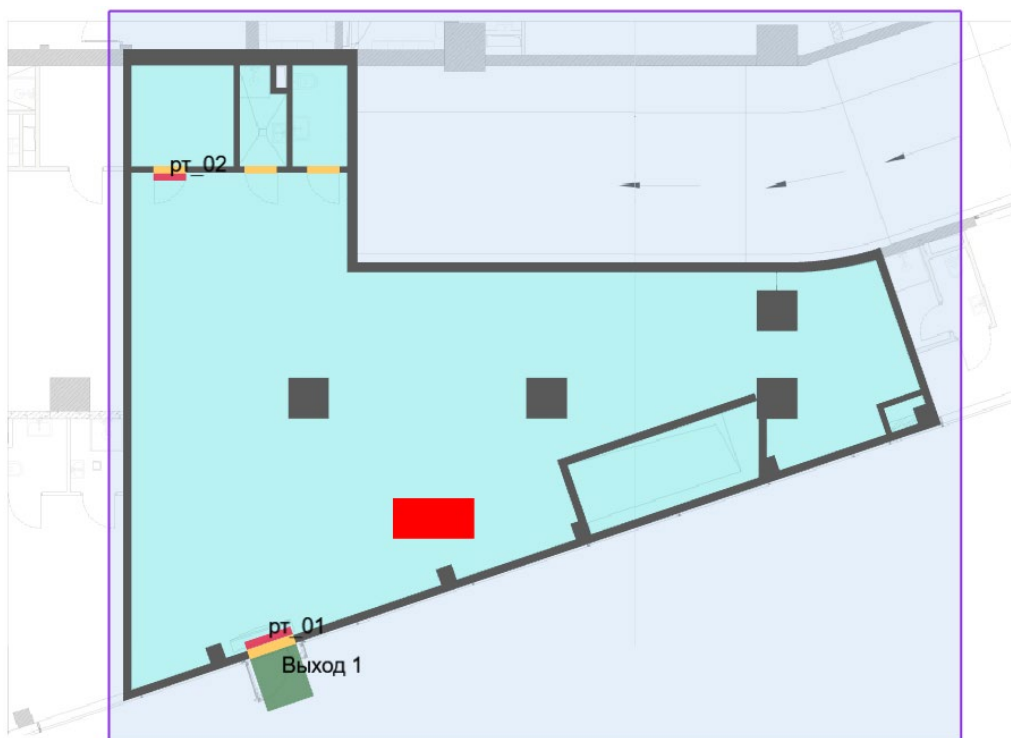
План 1-го этажа и нанесенная на него расчетная (принципиальная) схема эвакуации
